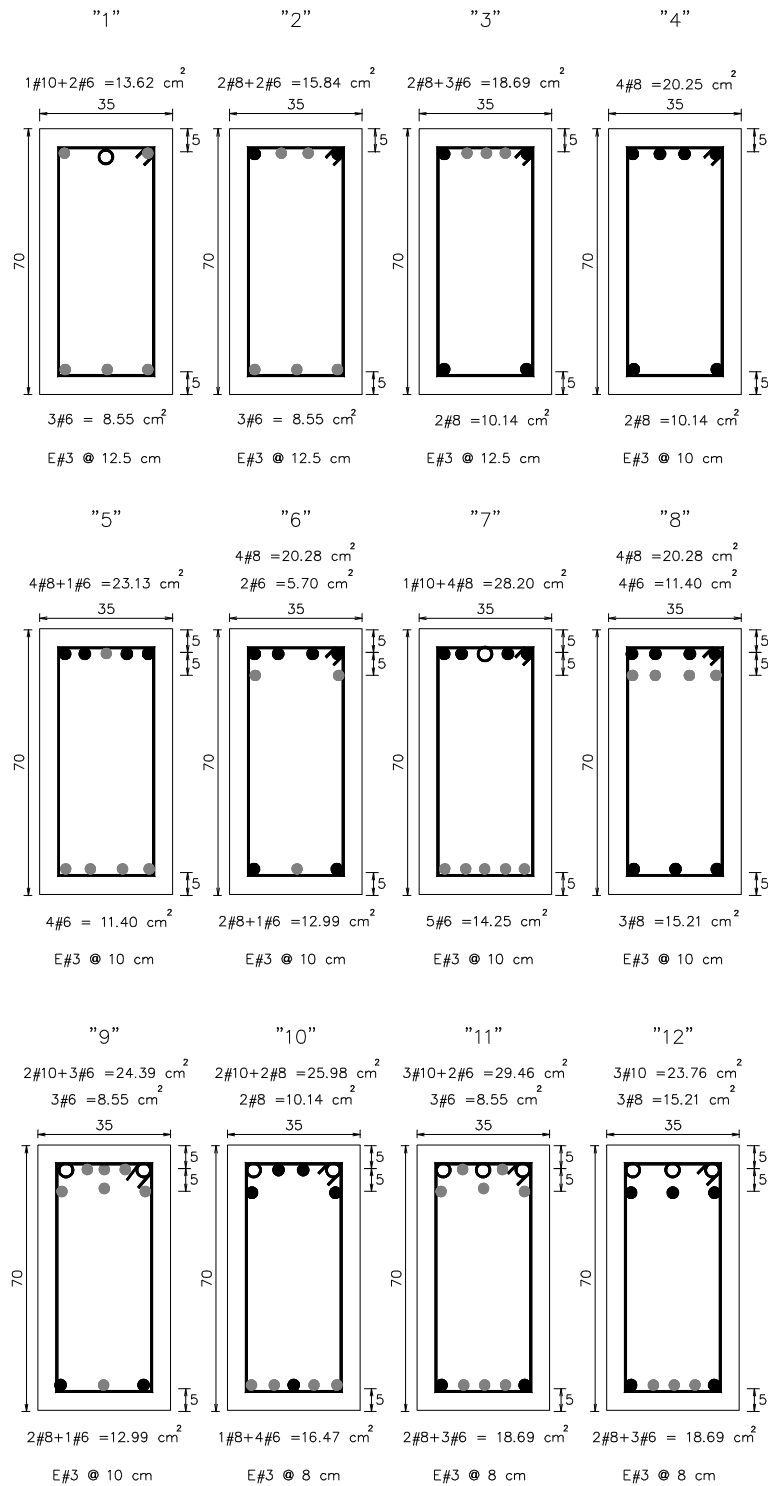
Tipos de armados propuestos para los extremos de las vigas del eje 2, estructuras de 17 niveles diseñadas en zona II (RDF-93 y RDF-04)
